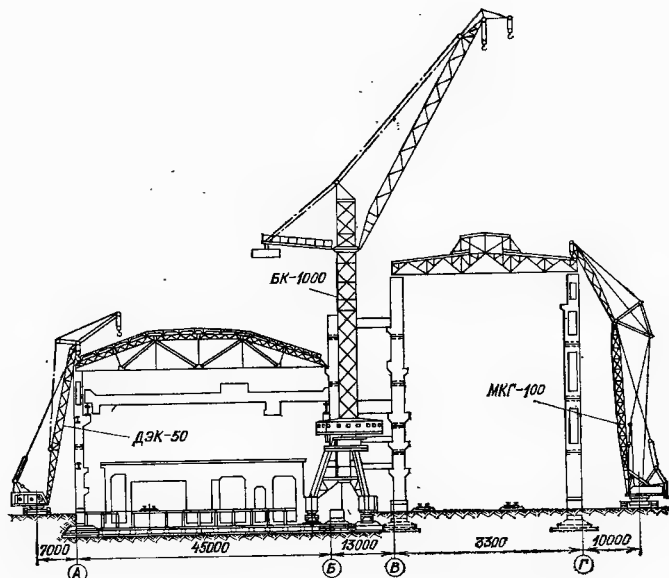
Монтаж наземных строительных конструкций башенным и гусеничными кранами
